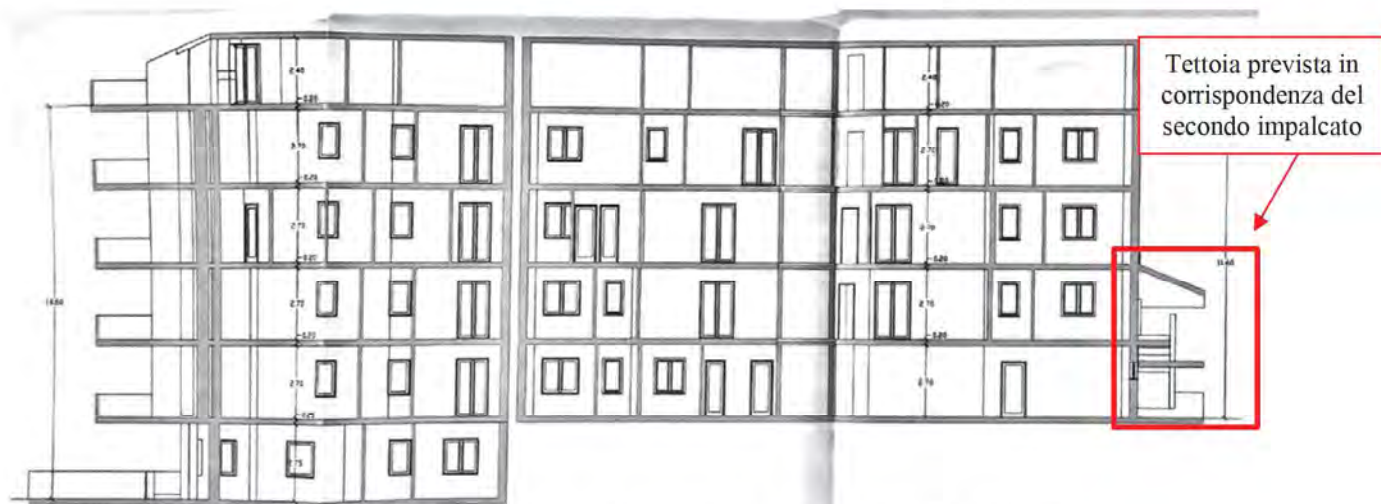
Sezione progetto approvato con permesso di costruire in variante n.59 del 22/07/2008.
